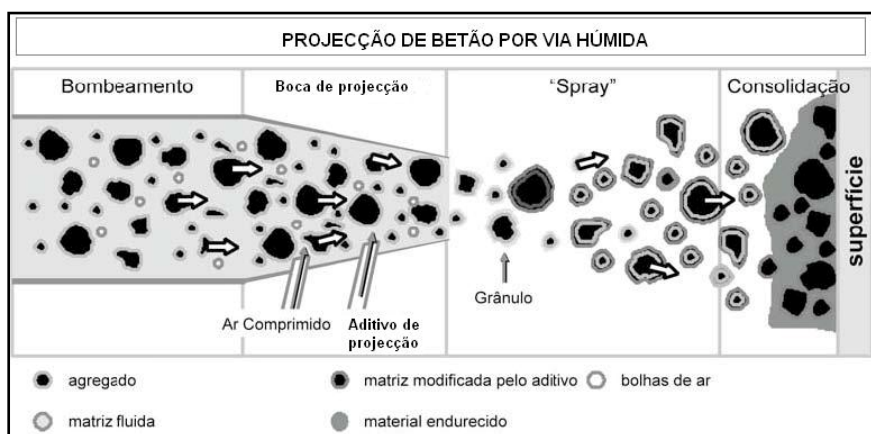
Ilustração esquemática da aplicação do betão projectado.
